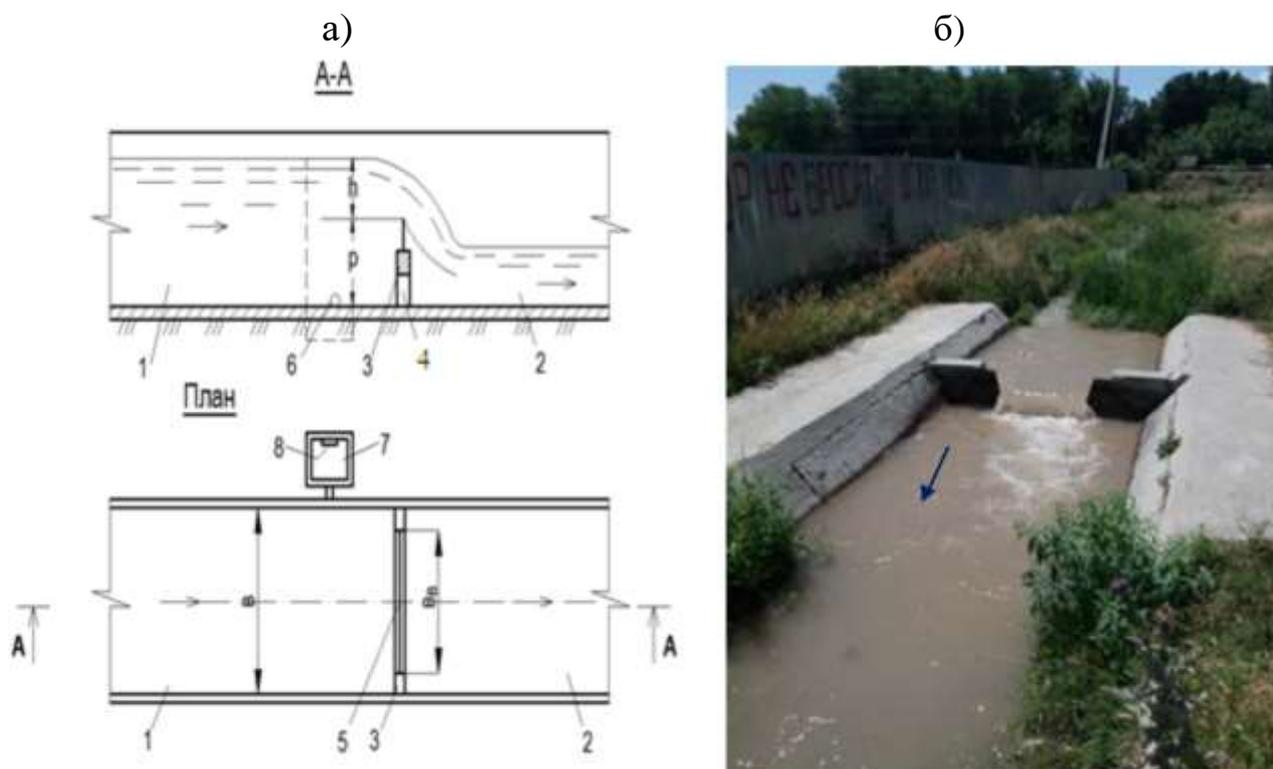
Схема водомерного сооружения типа «Водослив с тонкой стенкой». 1, 2 – подводящий и отводящий каналы; 3 – диафрагма; 4 – наносопромывное отверстие; 5 – водослив; 6 – соединительное (водопроводящая) труба; 7 – успокоительный колодец; 8 – уровнемерная рейка.
